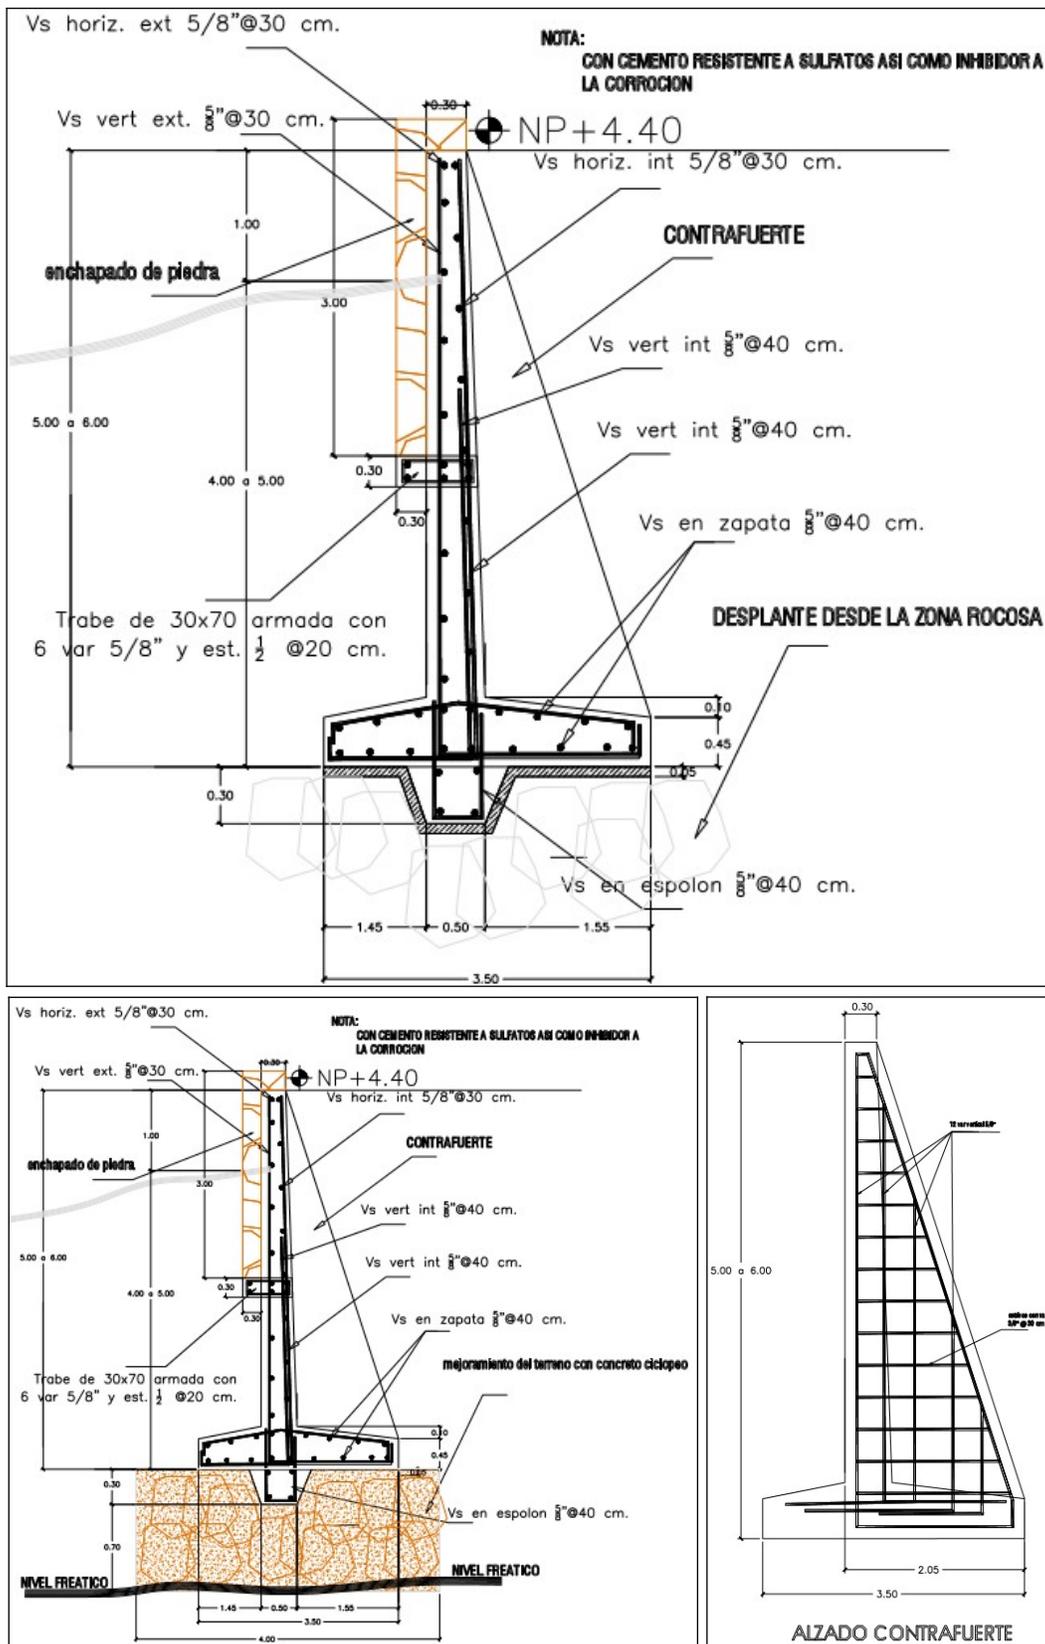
Diseño y dimensiones del Muro de Protección Cabo Beach.
